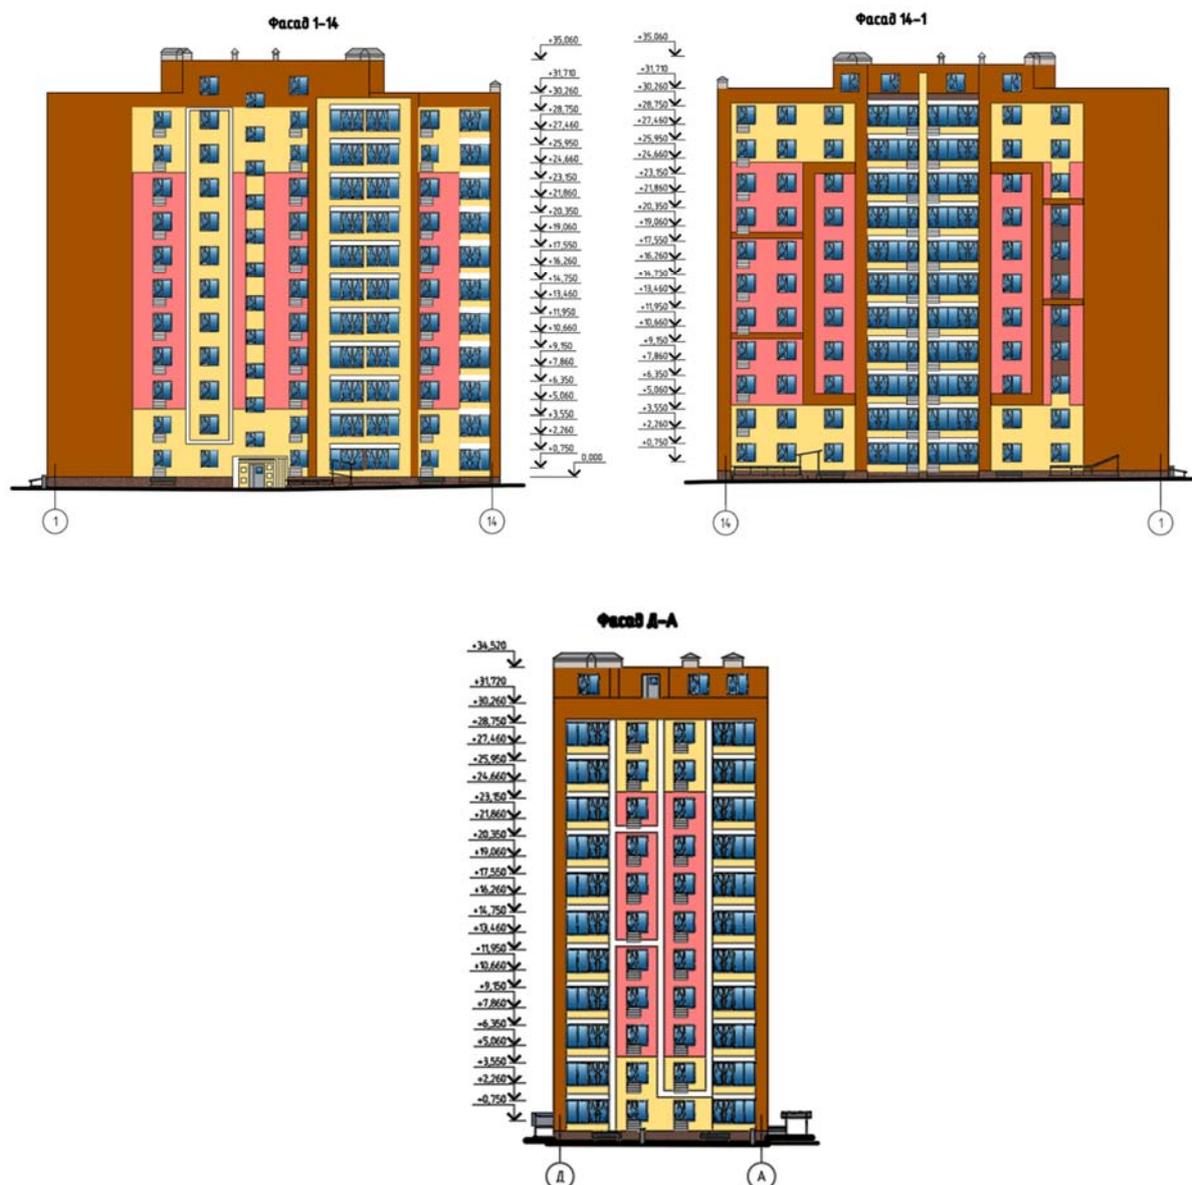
Фасади будівлі в кольоровому оформленні
